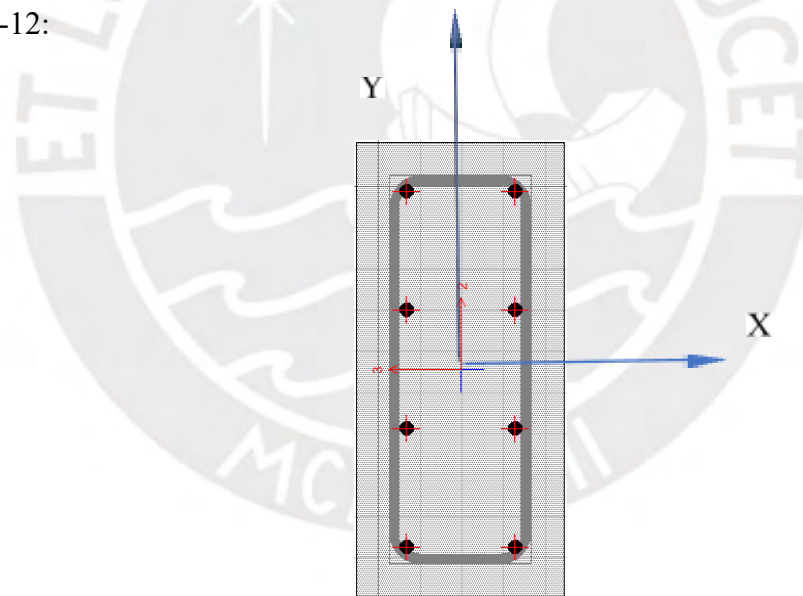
15. Sección de columna C-12 (Fuente - ETABS)
